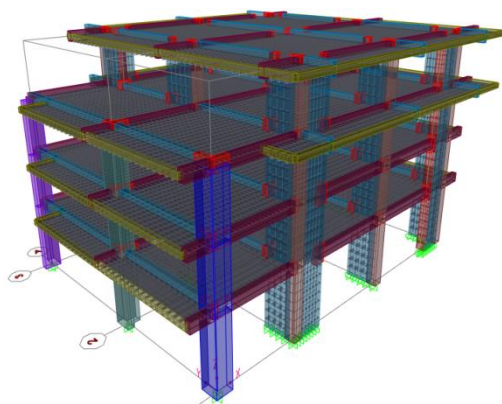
Modelo 3D muestra las conexiones de brazos rígidos
